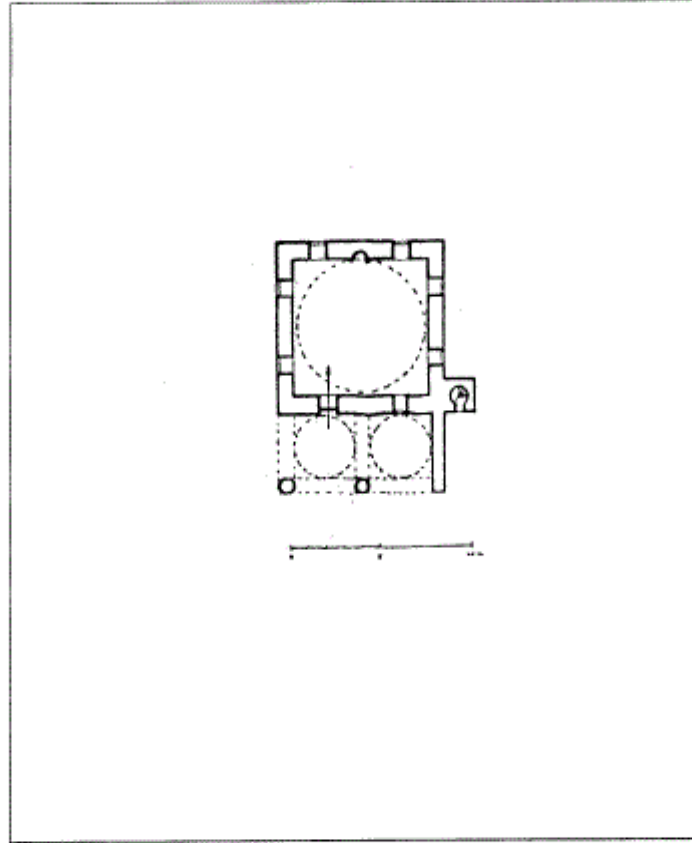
مكرر) مسقط أفقي لمسجد علي باشا في Szigetvár المجرية (عن : جيرو) .
